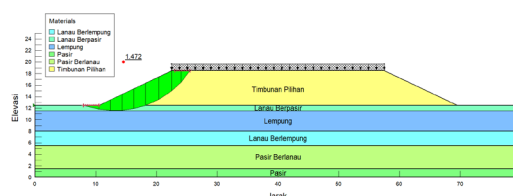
Nilai SF Lereng Timbunan 10 m dengan Beban Lalu Lintas
